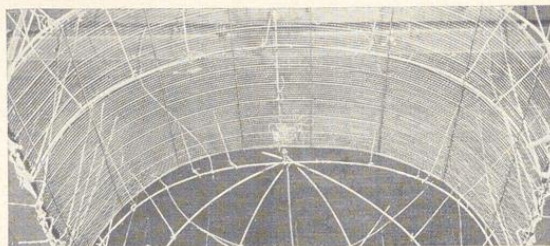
Mit Baustahlmatten ausgespannte Gewölbefläche
